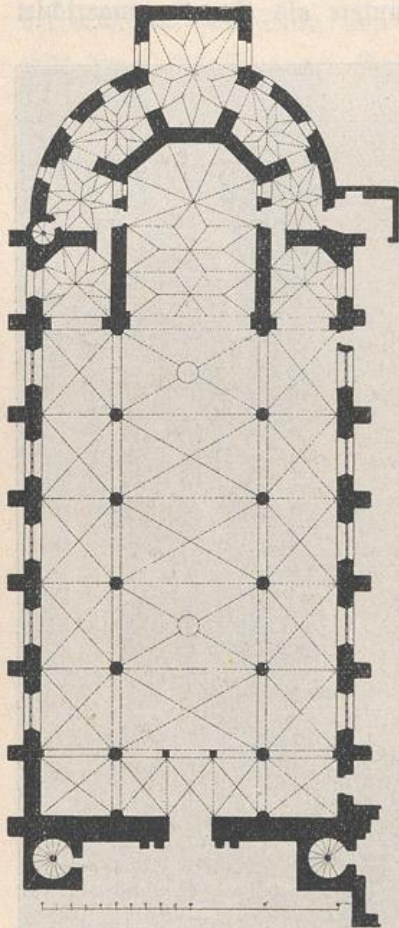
Bugensburg. Ehemalige Jesuitenkirche. Grundriß.
